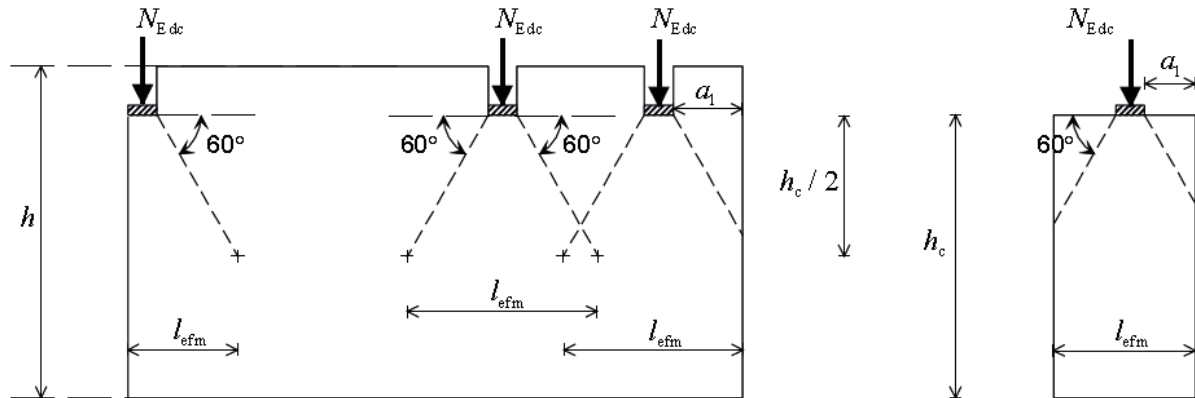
EC6-1-1: Teilflächenpressung 1) Grundriss 2) Schnitt
